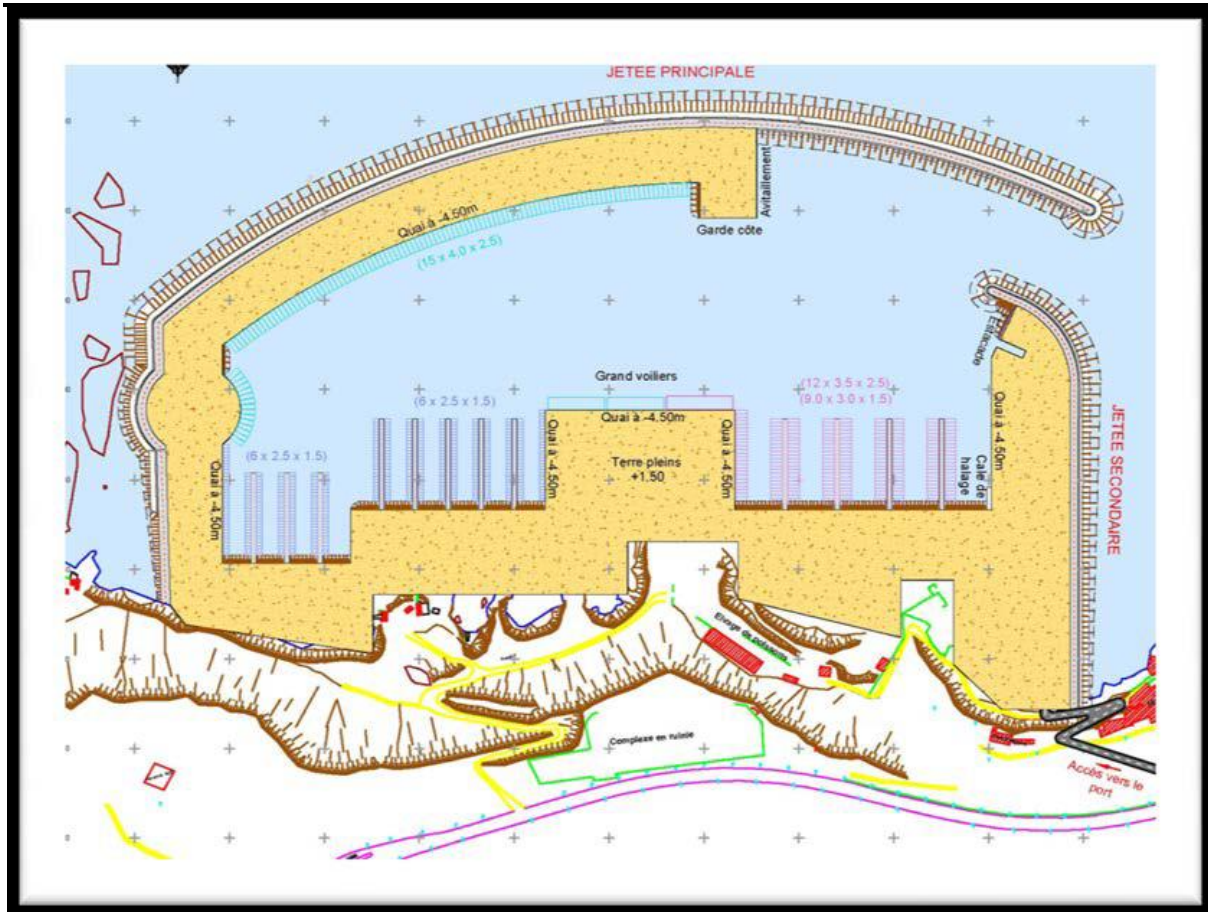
Plan de masse de la variante 01 (LEM)
